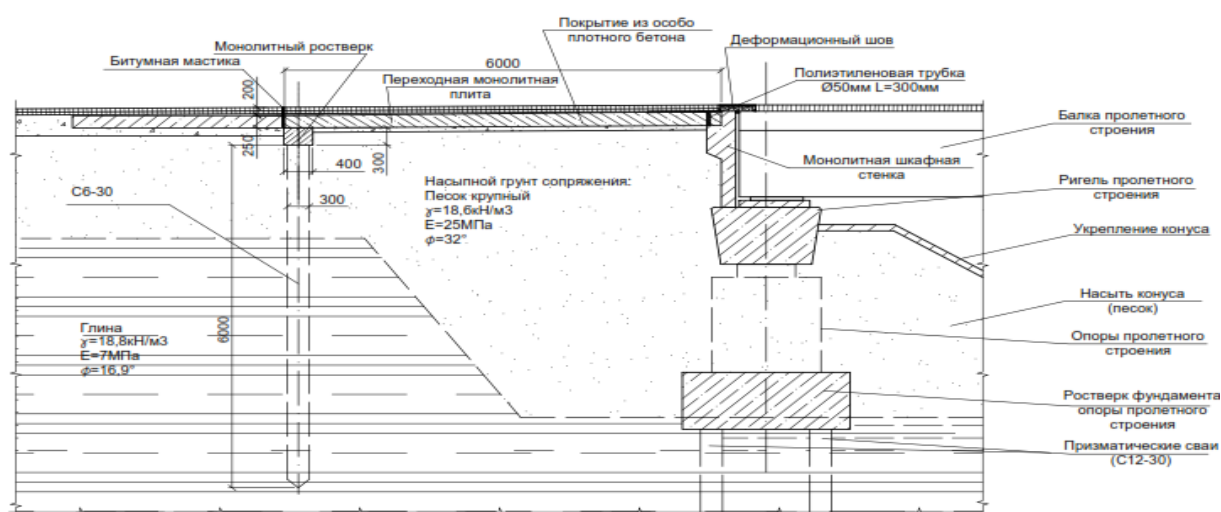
Конструкция устройства сопряжения на свайном фундаменте с монолитным ростверком
